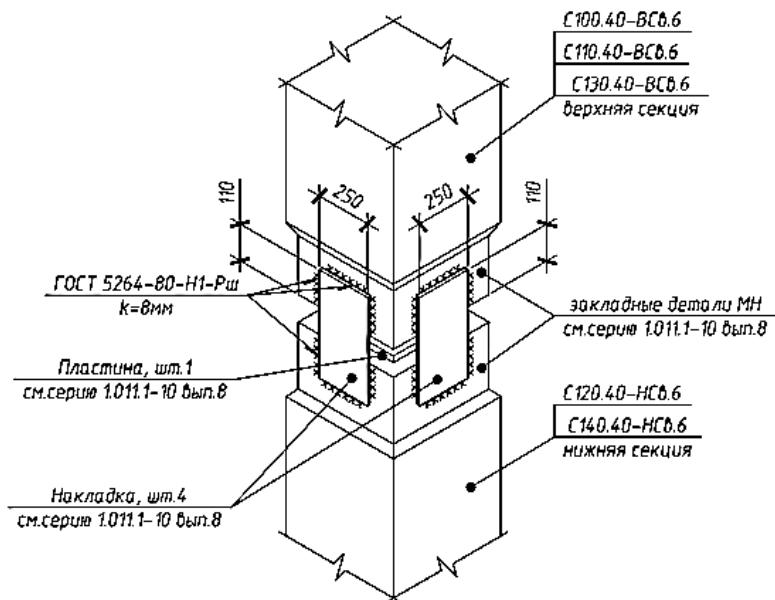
Схема сварного стыка верхней и нижней частей составных свай
